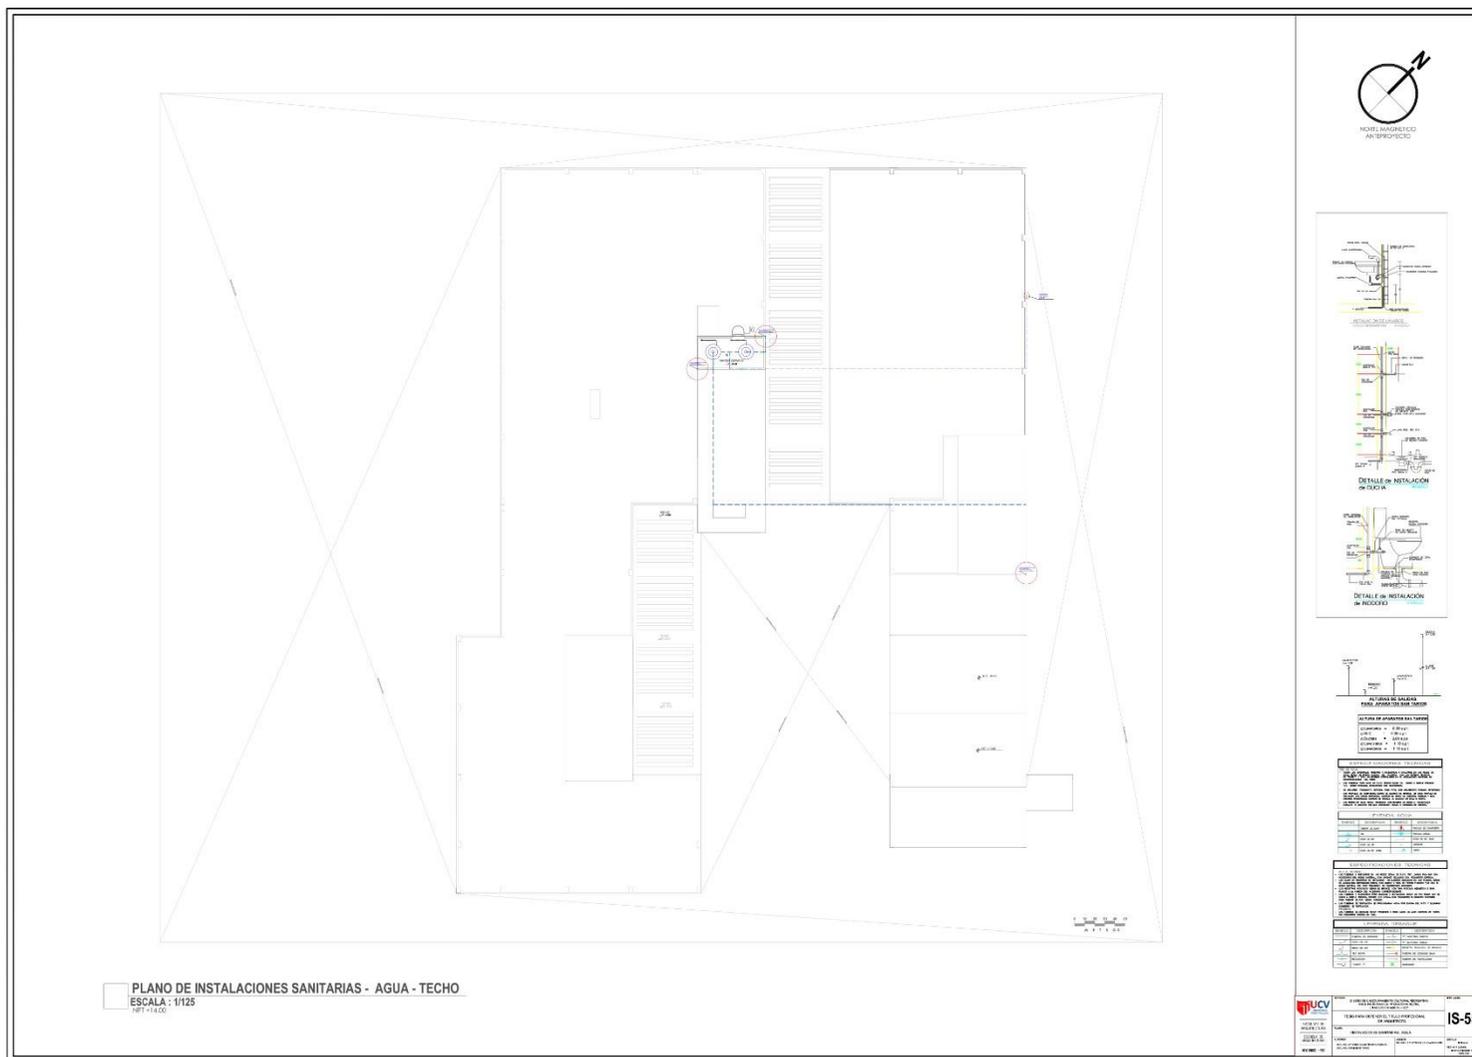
Plano de Instalaciones Sanitarias Nivel Azotea Techo
